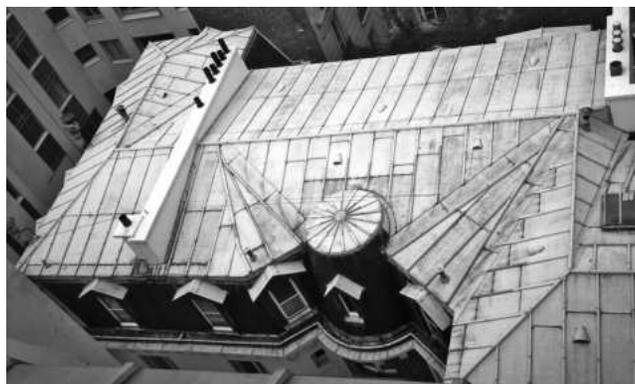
Toiture en zinc (fin du xix^e siècle)
